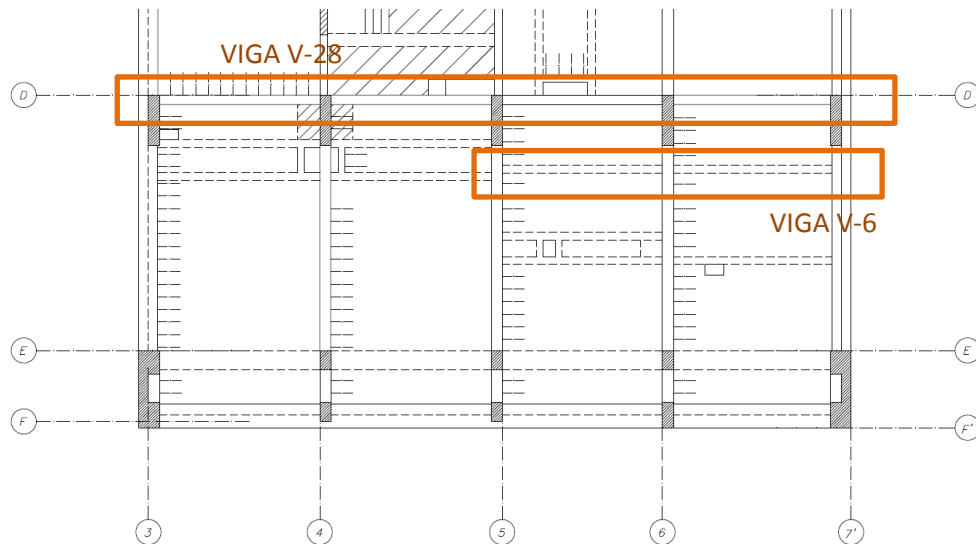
Planta del nivel 4 indicando viga chata V-6 y viga peraltada V-28.
